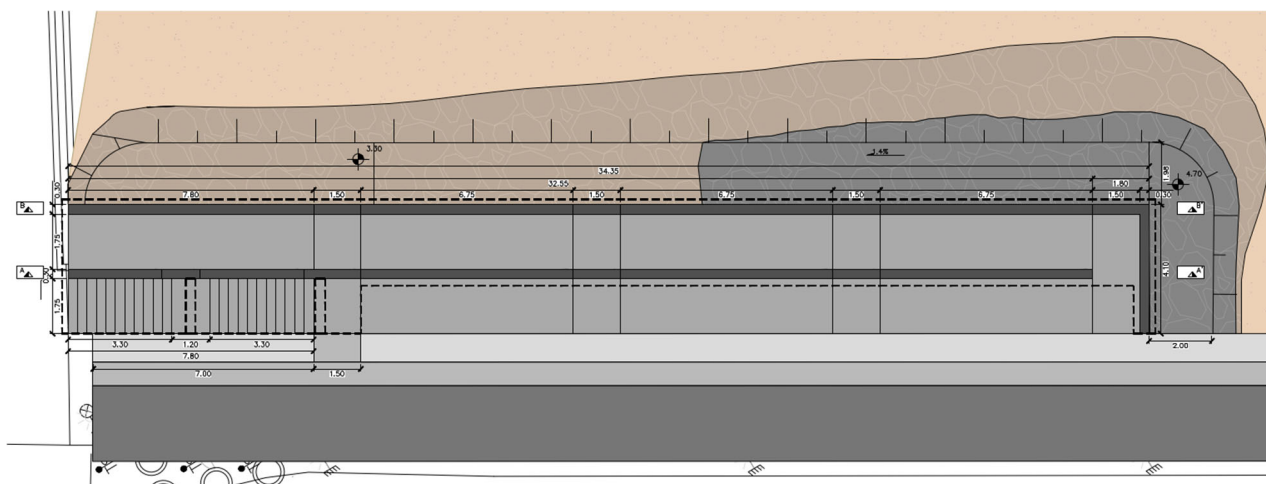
Planta general de la rampa d'accés al passeig-mirador.
